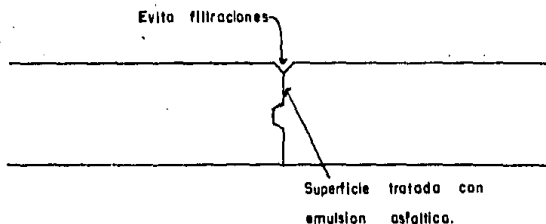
Junta de construcción usada como junta de construcción en un muro
